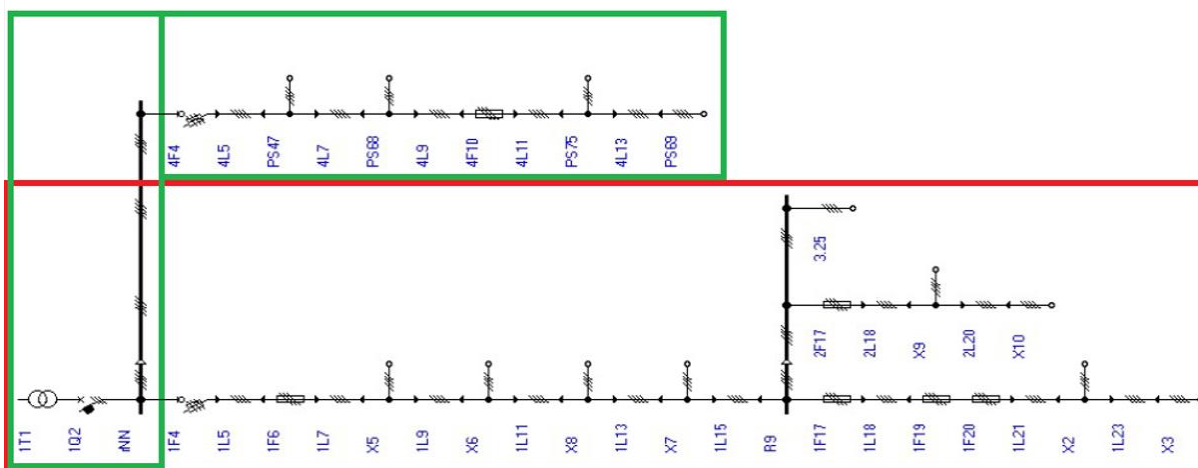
Odběrné místo č. p. 75; zdroj: autor.
